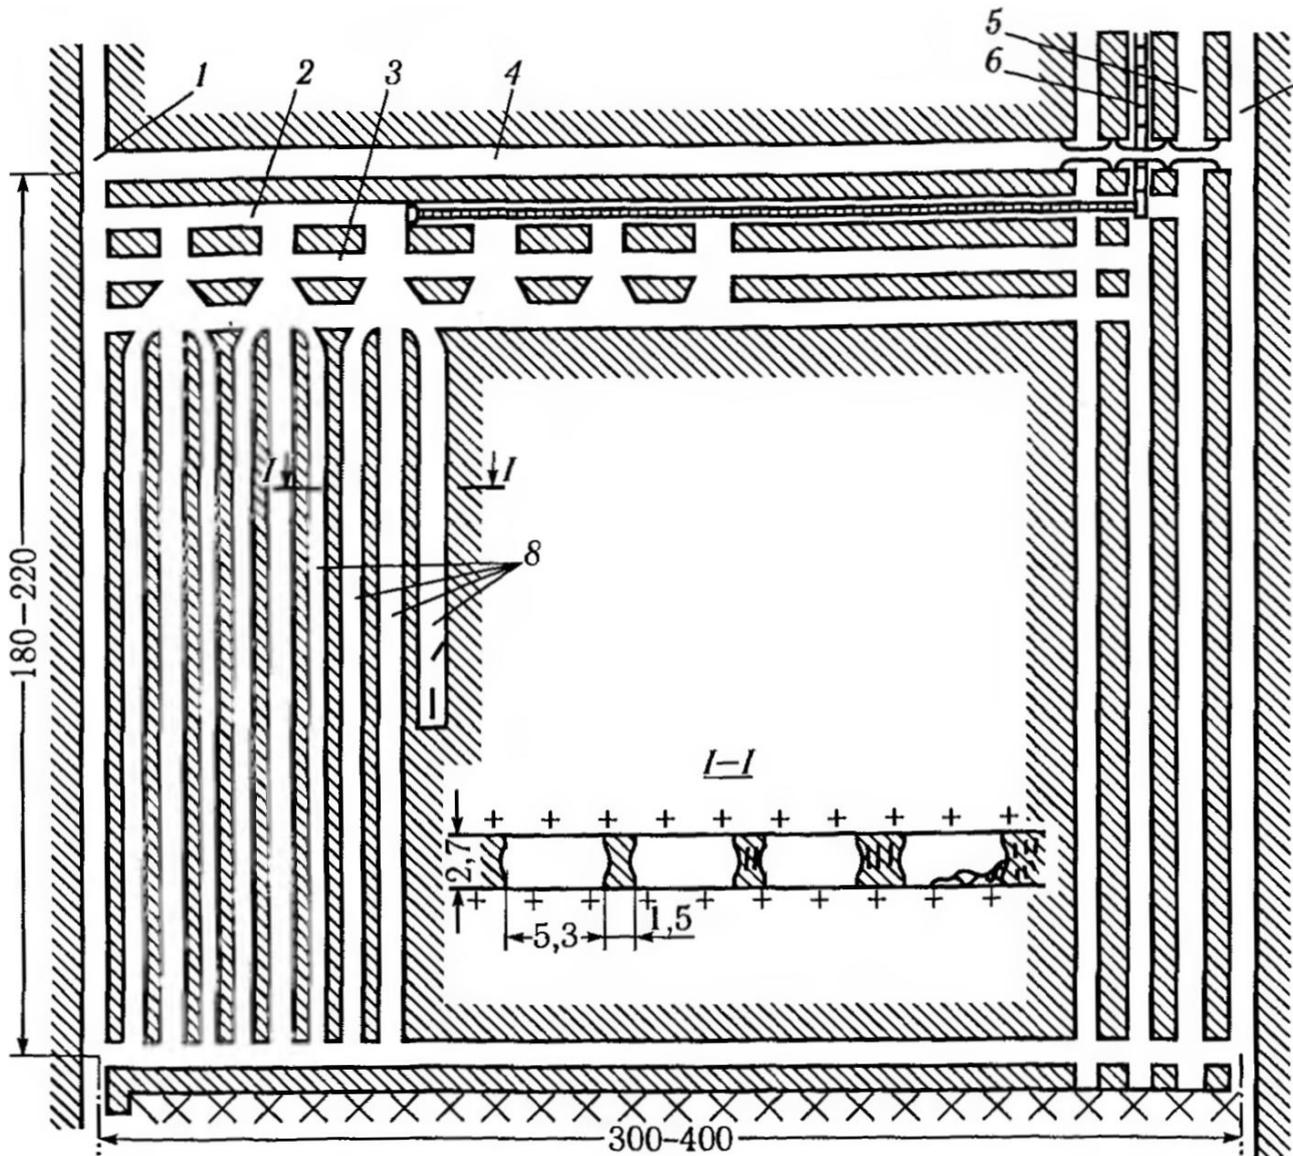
Камерная система разработки с плавной посадкой кровли на податливых (разрушаемых) целиках: 1 – панельный вентиляционный штрек; 2 – боковой конвейерный штрек; 3 – боковые выемочные штреки; 4 – боковой разгружающий (вентиляционный) штрек; 5 – панельные транспортные штреки; 6 – панельный конвейерный штрек; 7 – вентиляционный штрек следующей панели; 8 – камеры
